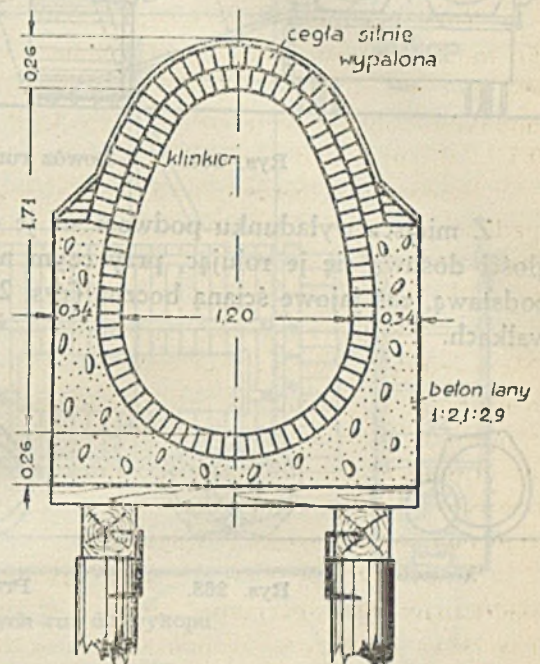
Kanał oparty na palach żelbetowych (Frankfurt nad Menem, wykonano bez dostępu powietrza do gruntu bagicznego).
